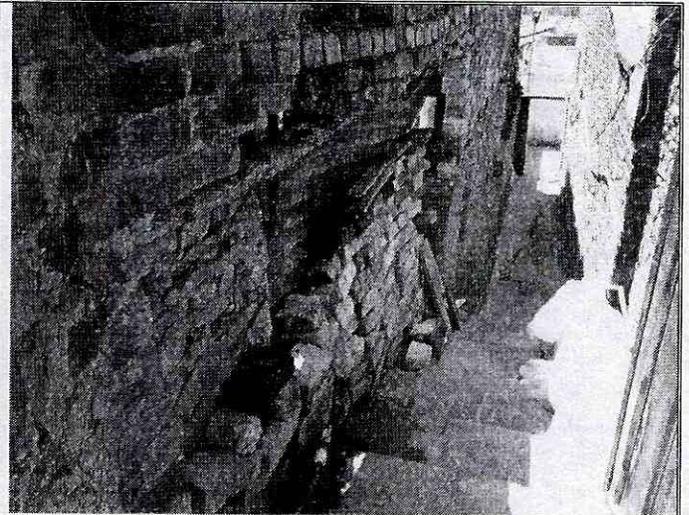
Muro en ladrillo recosido ubicado al costado nor-oriental de la vivienda evaluada, el cual presenta embombamiento y colapsos parciales de mampostería que dejan inestable todo el muro y susceptible a colapsos adicionales y/o totales.
